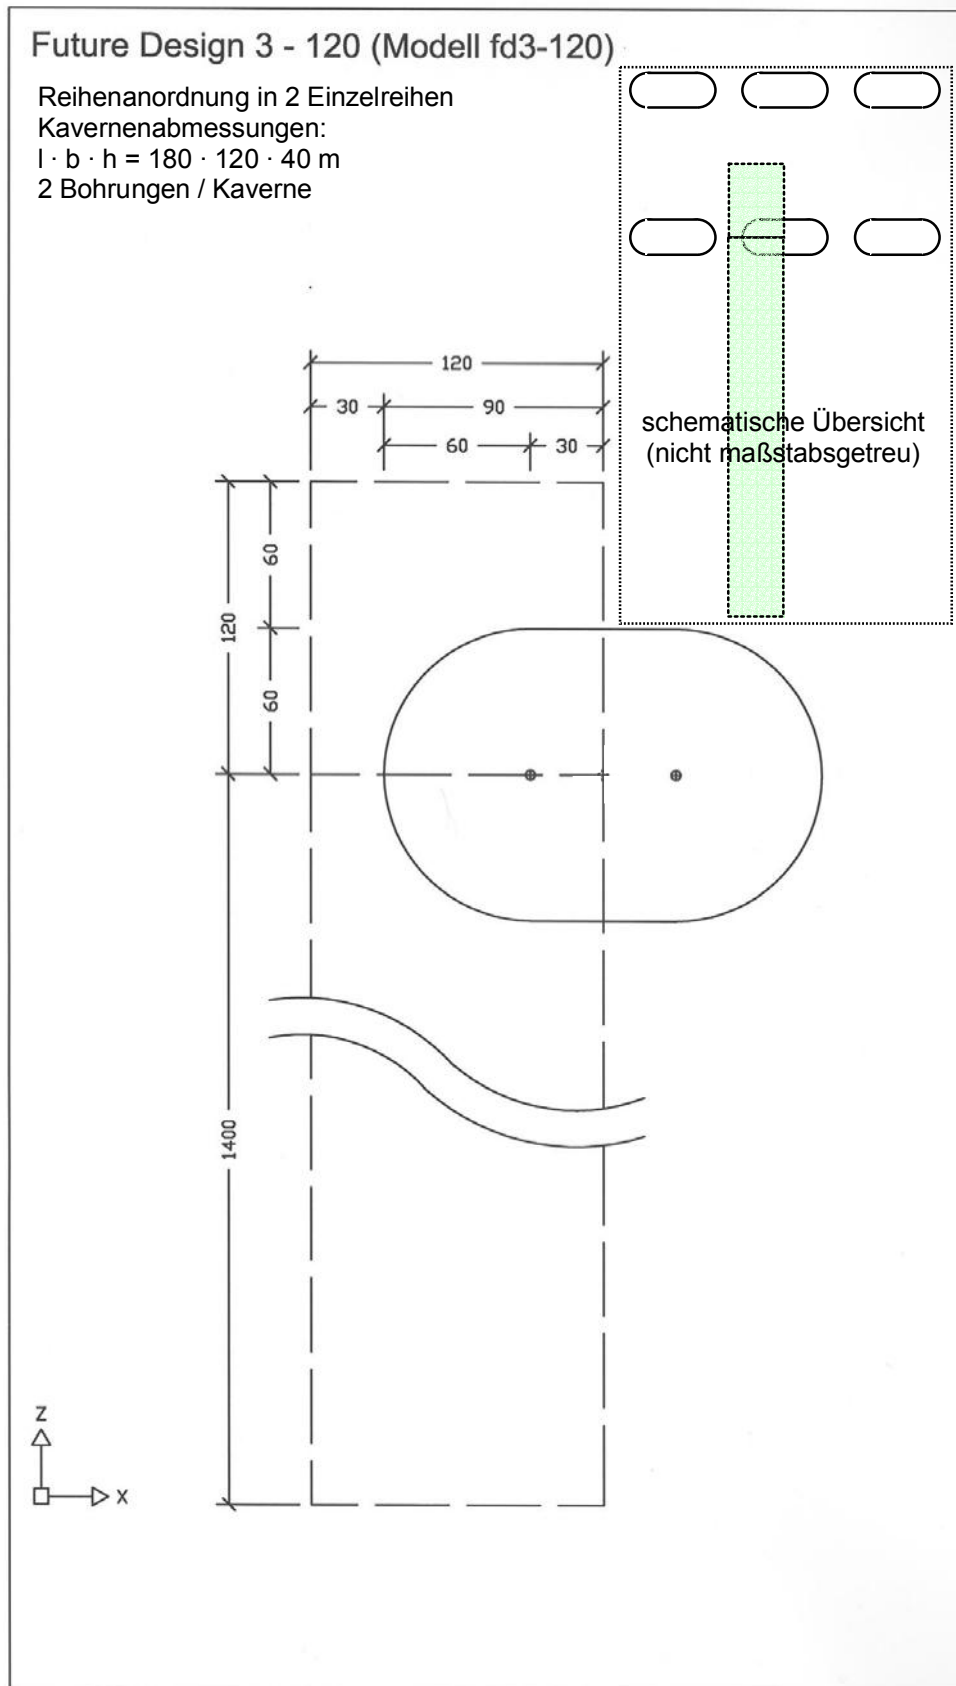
Future Design 3-120 – Grundriss
